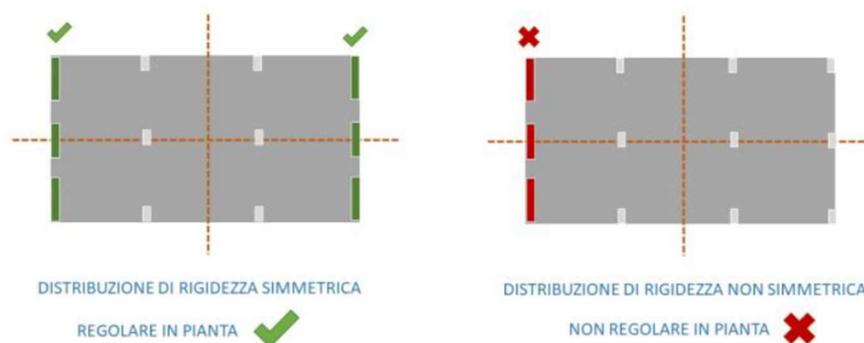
Irregolarità in pianta (distribuzione delle rigidezze)
